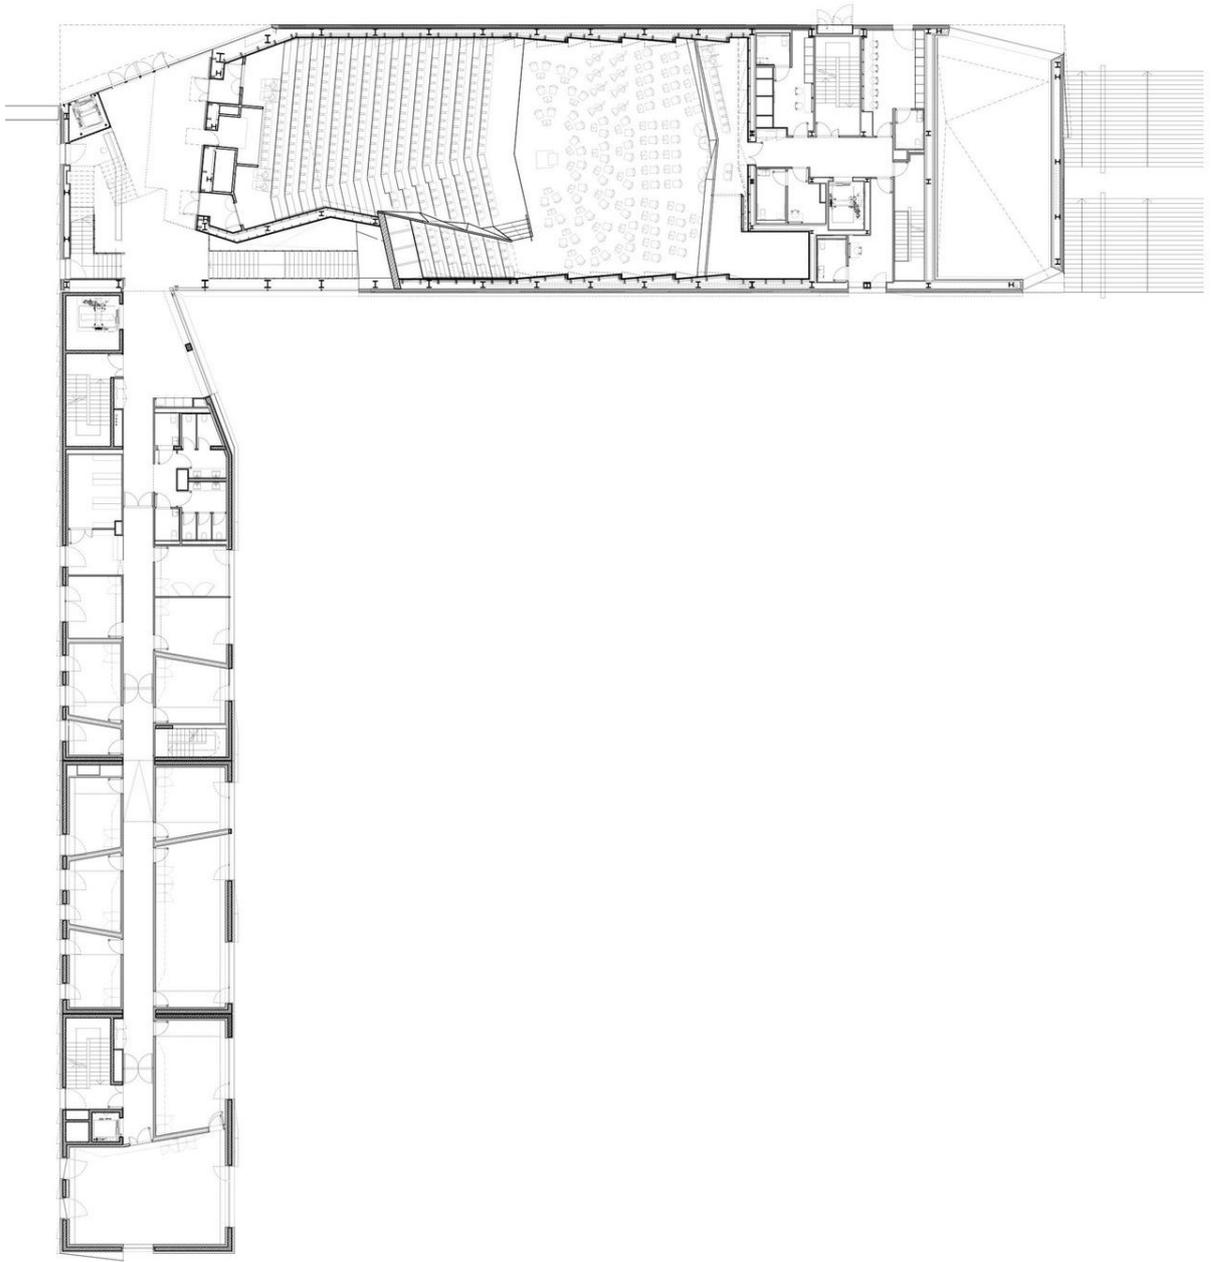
Planta do primeiro pavimento, onde acontece o principal acesso do edifício (FONTE: Archidaily, 2014).
